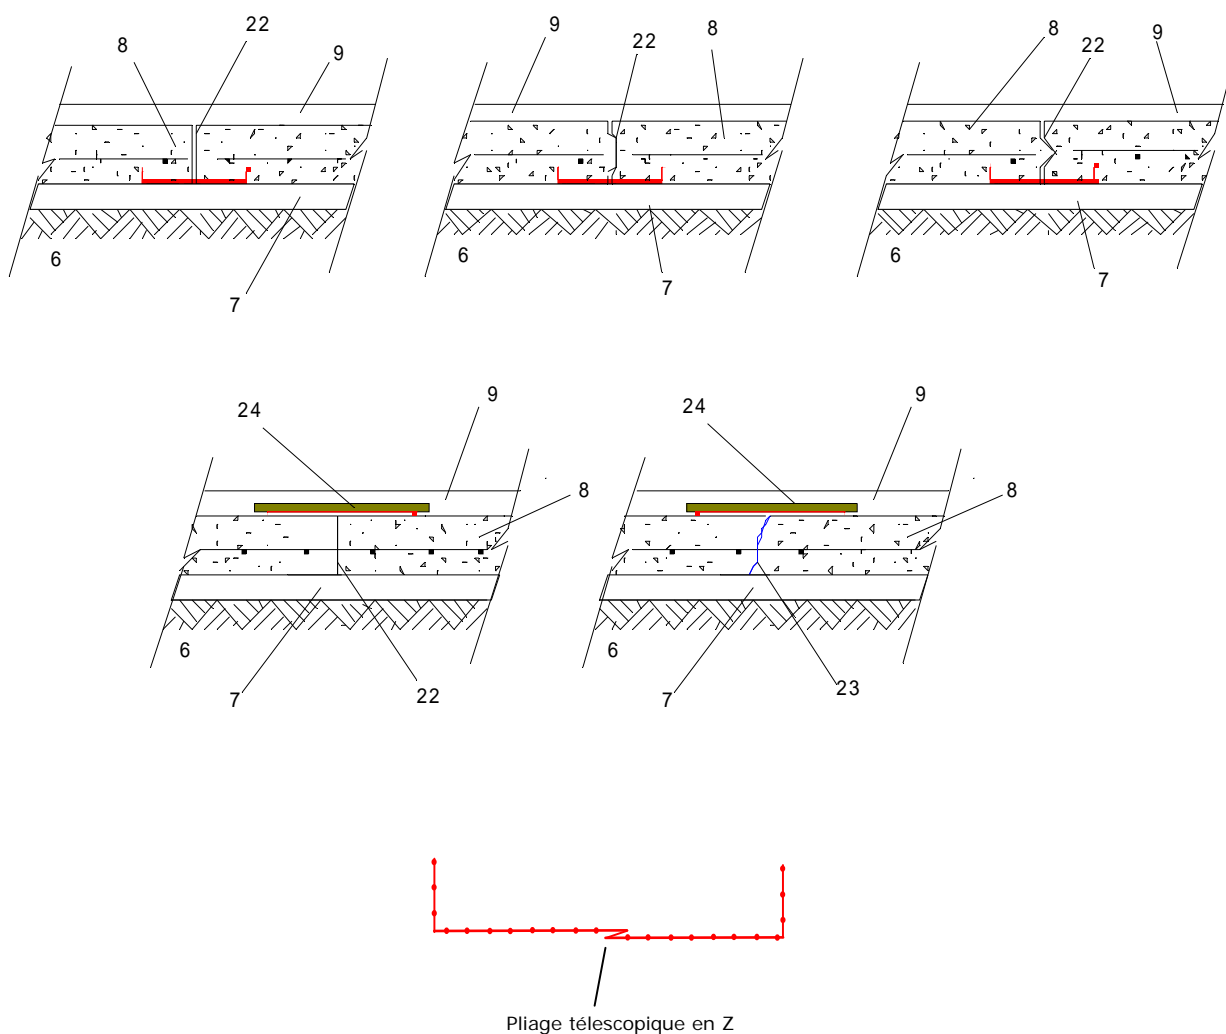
EU 8.4-1_joint de dilatation – fissures traversantes
